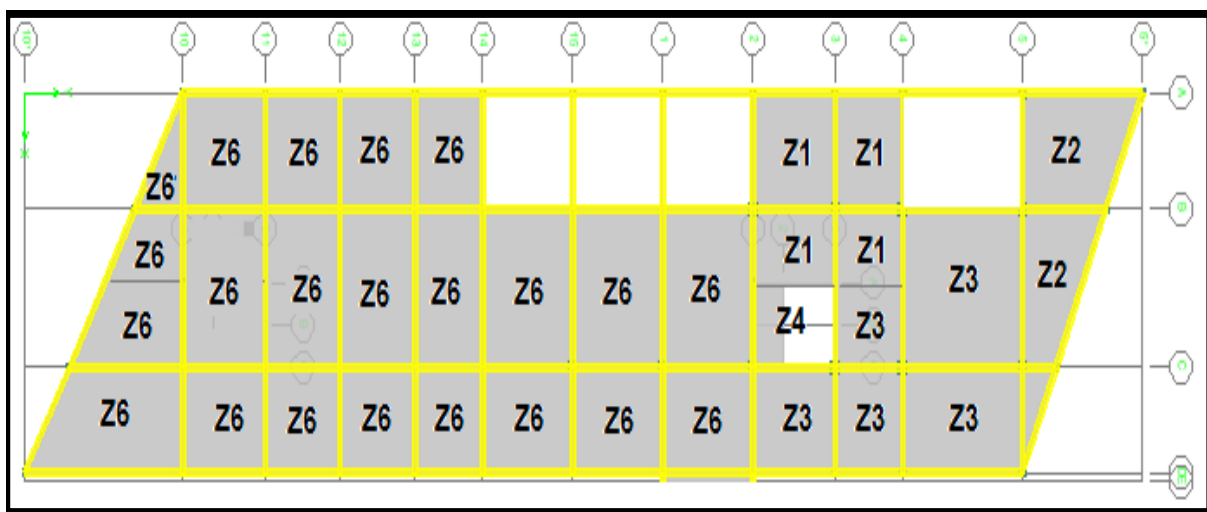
Zonas de la Edificación. Edificio Norte (Nivel 2).
